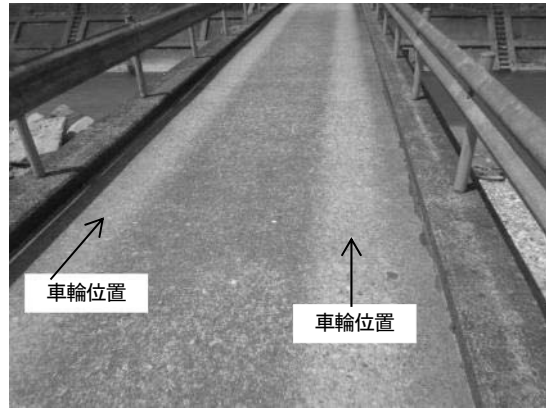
大蔭橋の路面の状況 (2014.6)
